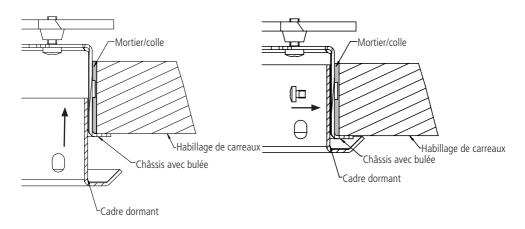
Lors de la finition du poêle, une traverse dormante Fig. 2.18 Cette traverse dormante masque le châssis luiest introduite et vissée dans le châssis de montage.
